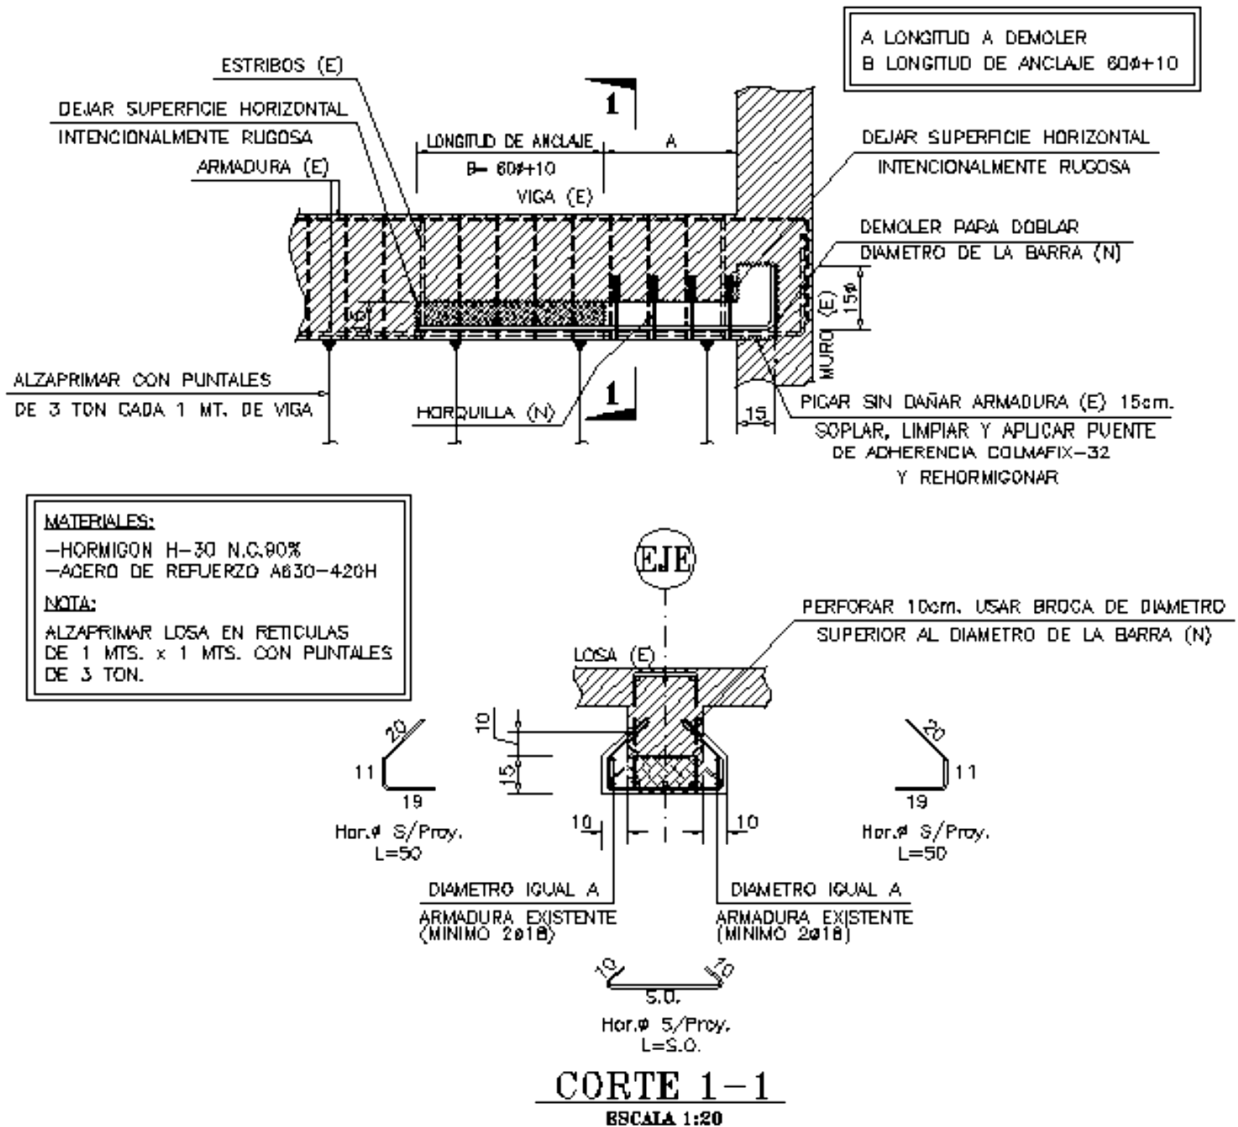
Esquema de reparación interfaz viga - muro, Piso Subterráneo – Caso B.
